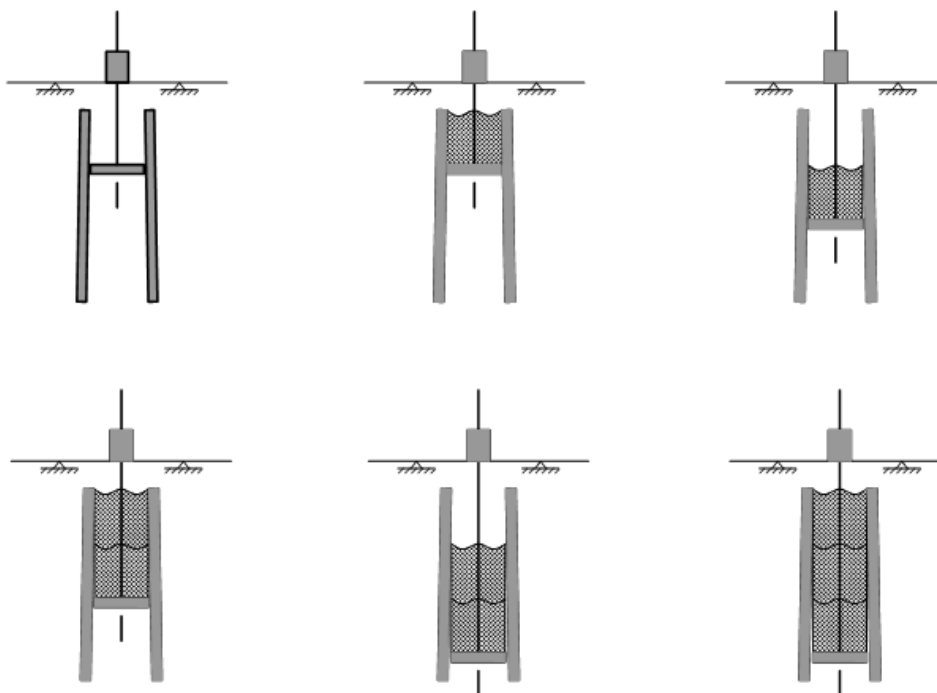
Принципиальная схема бетонирования методом опускающегося бетона по этапам
